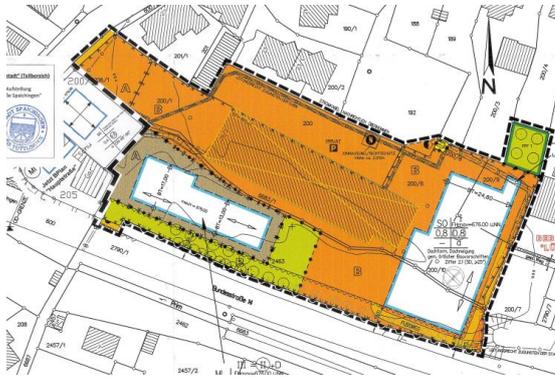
Ausschnitt B-Plan „Oberstadt I“
